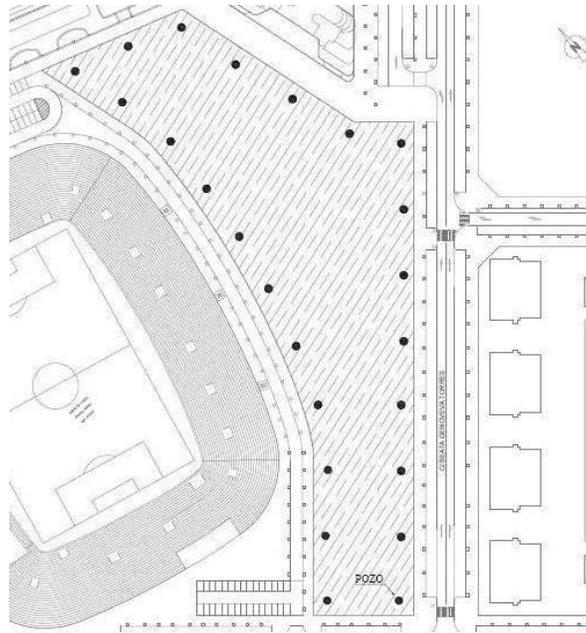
Esquema de la ubicación de los pozos en el interior de la parcela objeto de actuación.
